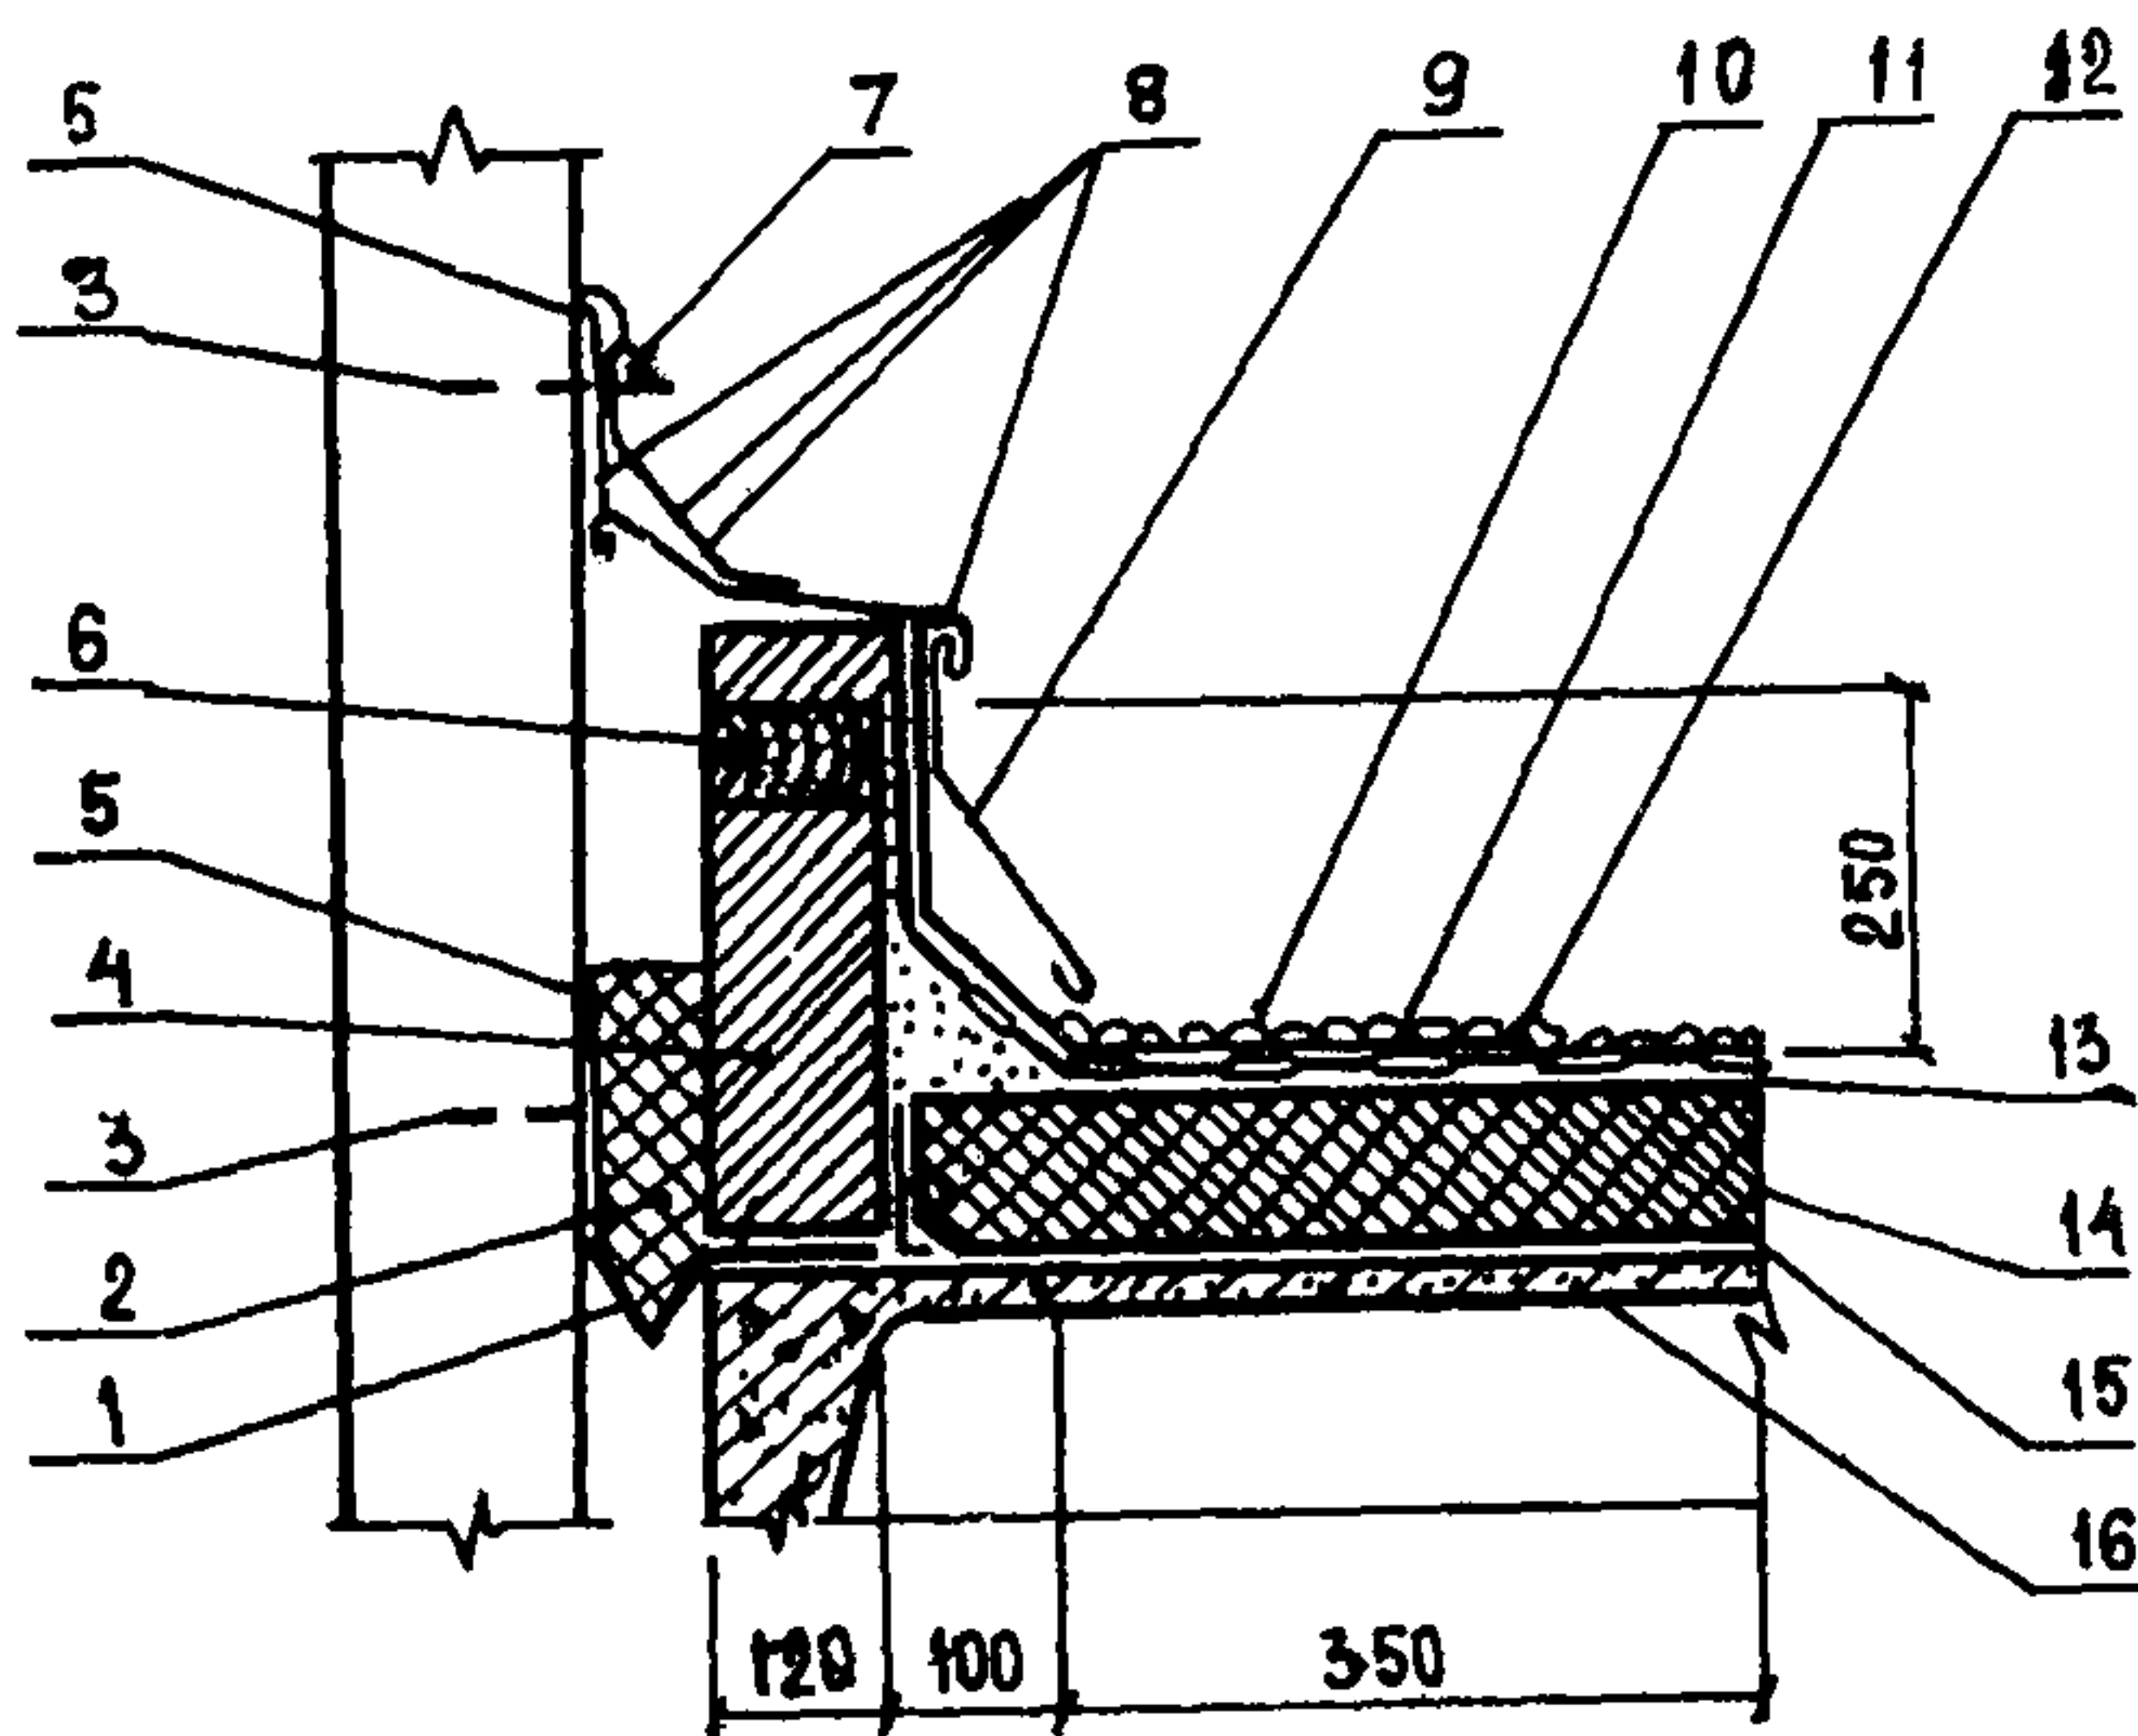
Продольный или поперечный температурный шов с перепадом кровли
